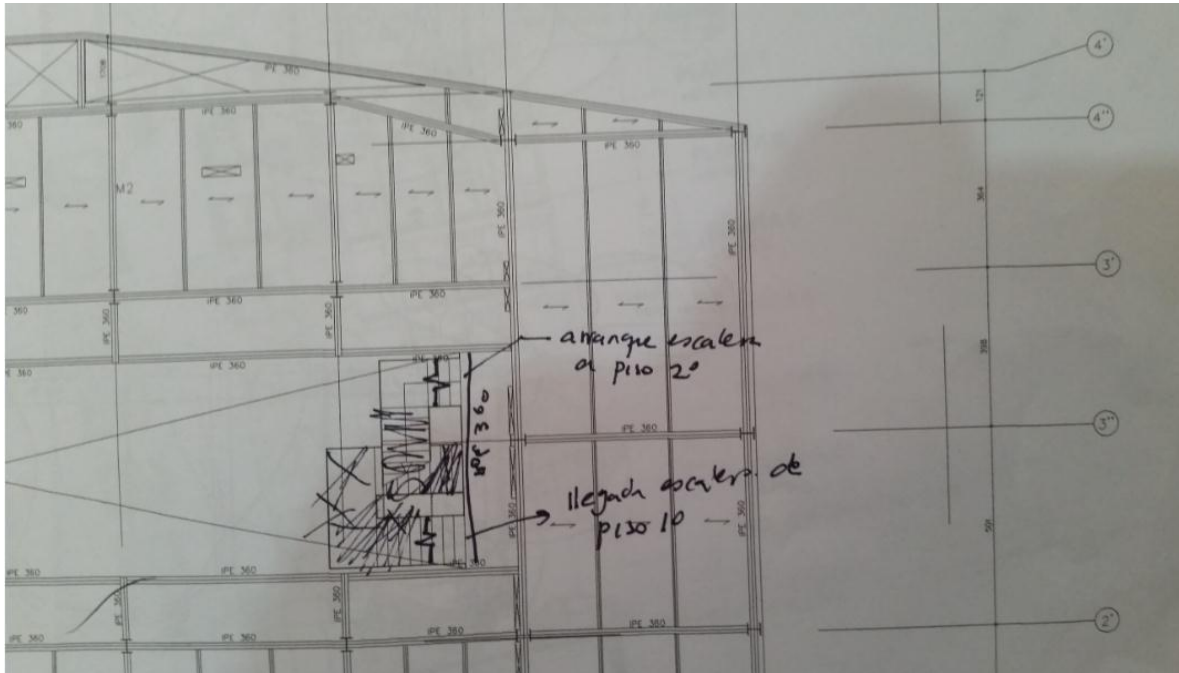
PROCEDIMIENTO DE LOCALIZACIÓN DE ESCALERAS EN PLANTA ESTRUCTURAL.
